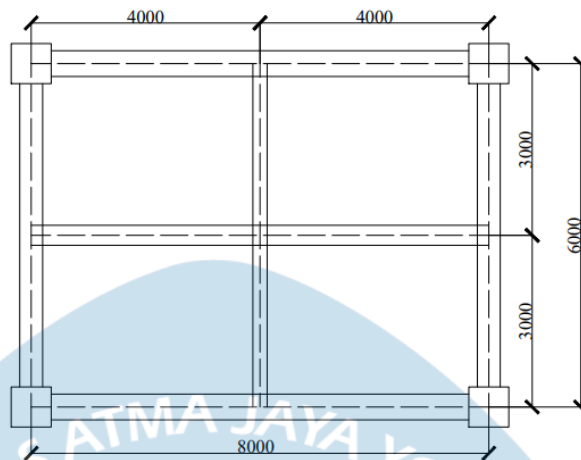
Denah Lantai 2 Bangunan Utama
